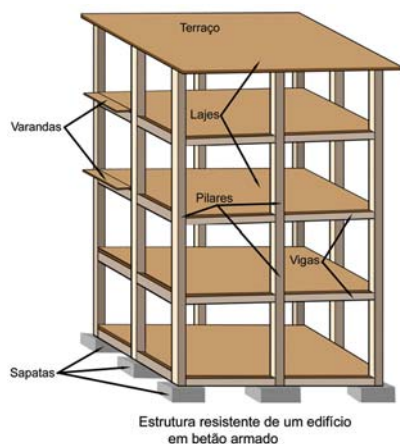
As lajes, as vigas e os pilares são exemplos de elementos resistentes de um edifício.
